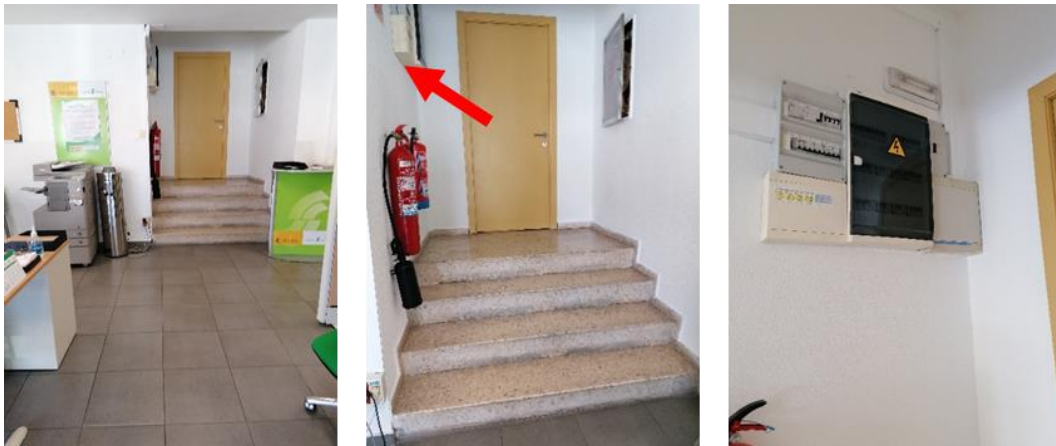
Cuadro eléctrico ubicado en la planta baja del centro de salud
